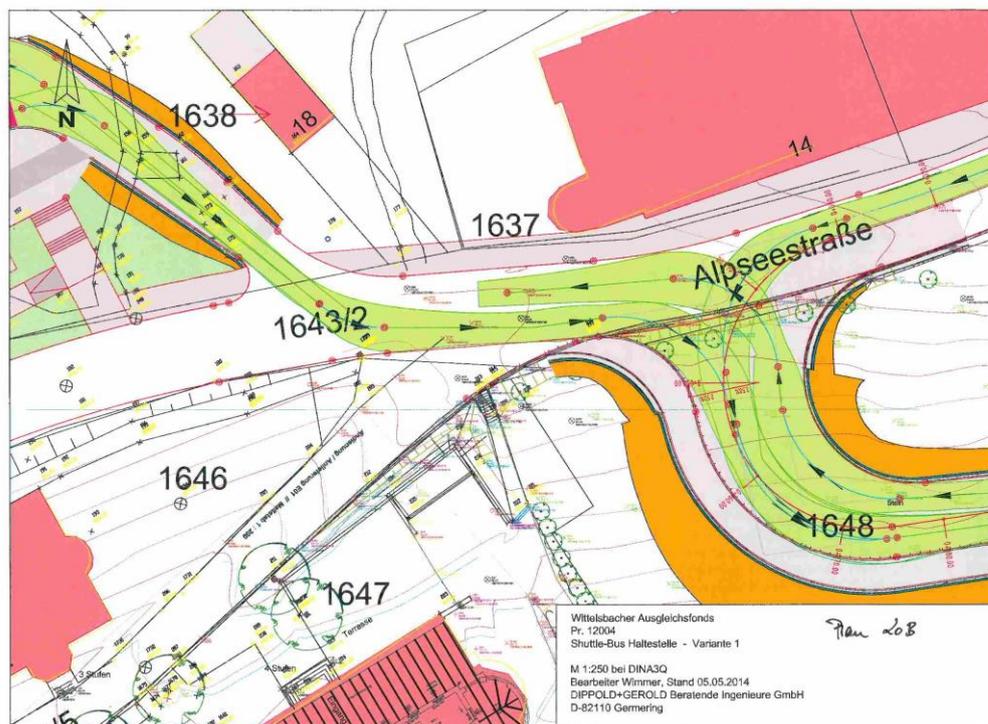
Verkehrsabwicklung vor Hotel Müller mit Anschluss zur geplanten Neuschwansteinstraße
